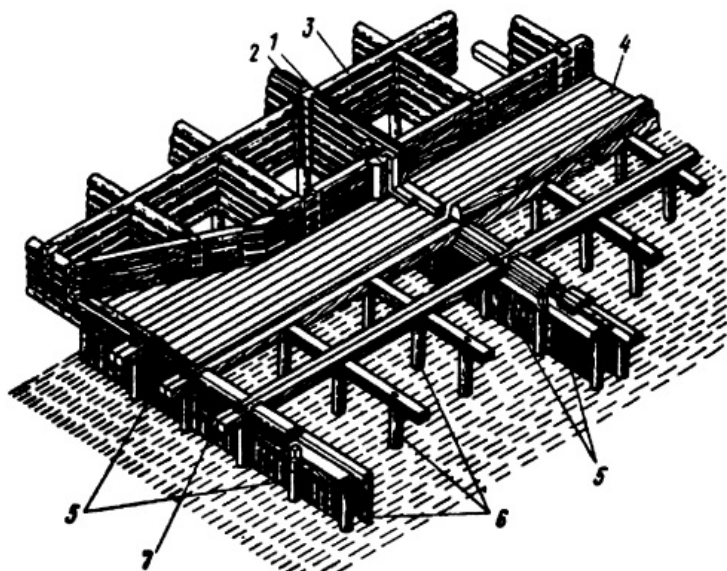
Свайный флютбет: 1— паз для щита; 2 — шпунтовый простенок; 3 — ряжевый береговой устой; 4 — пол водобоя; 5 — шпунтовая стенка; 6 — маячные сваи; 7 — связывающий подпольный брус.
